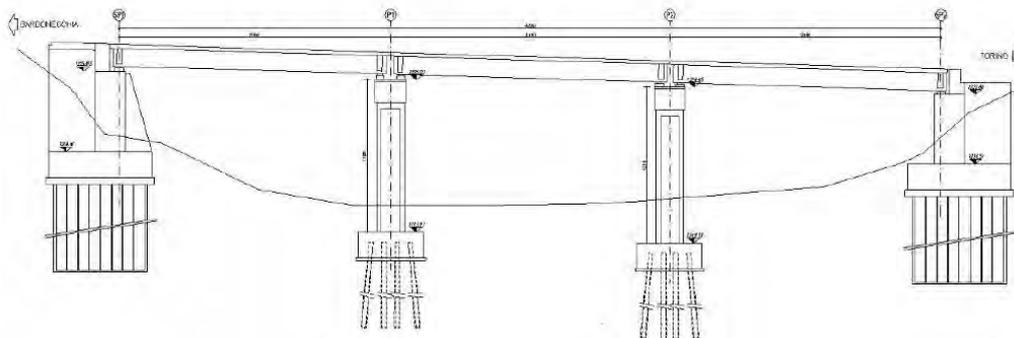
Planimetria generale (Fonte: Lista di controllo)
